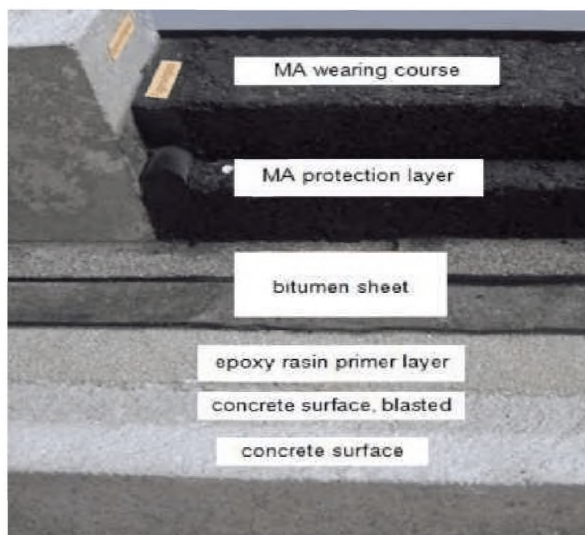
Конструкция дорожной одежды на железобетонной плите проезжей части с применением литого полимерасфальтобетона.
